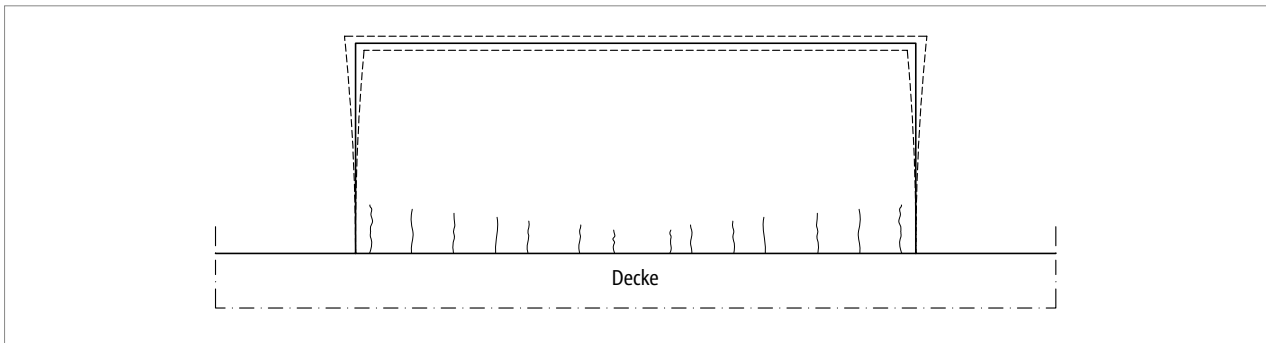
Balkonplatte ohne Schöck Isokorb®: Rissbildung durch Ermüdung möglich
